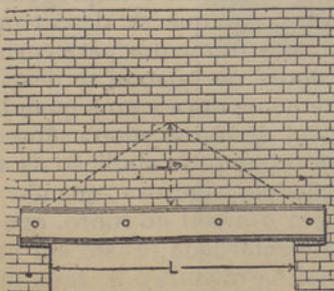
Trave suportando um muro de tijolo sem janelas
